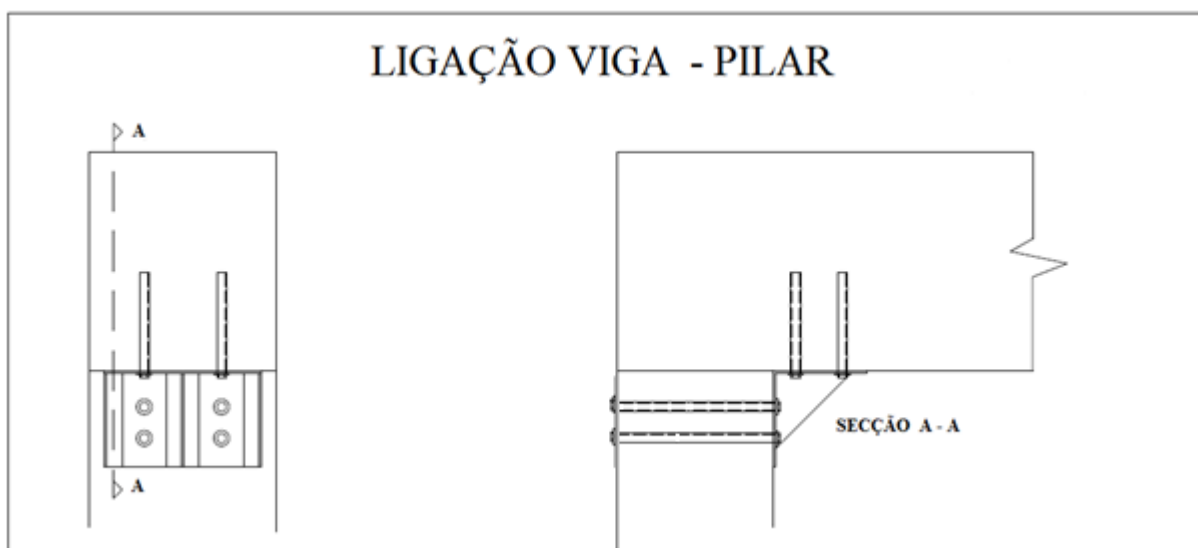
Detalhe da intervenção para a ligação entre viga e pilar no presente caso de estudo
